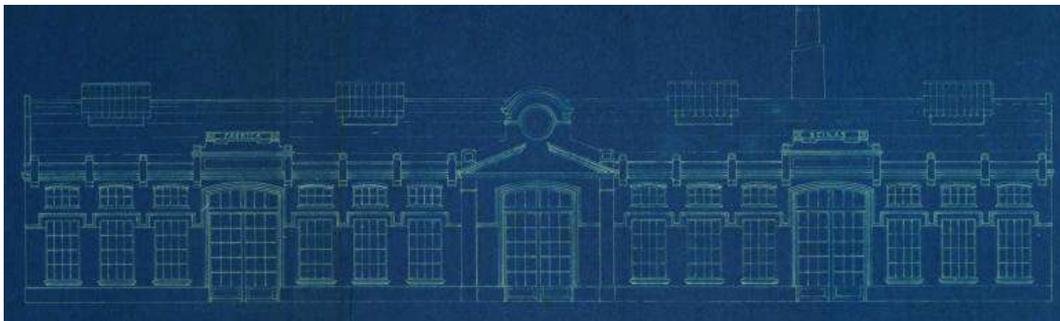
Fachada principal do pavilhão construído na segunda fase construtiva do polo industrial da Mitra, com a construção de uma oficina de tanoaria e serralharia, Setembro de 1913.
